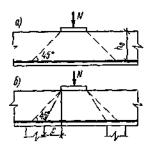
Схема пирамиды продавливания при угле наклона ее боковых граней к горизонтали
